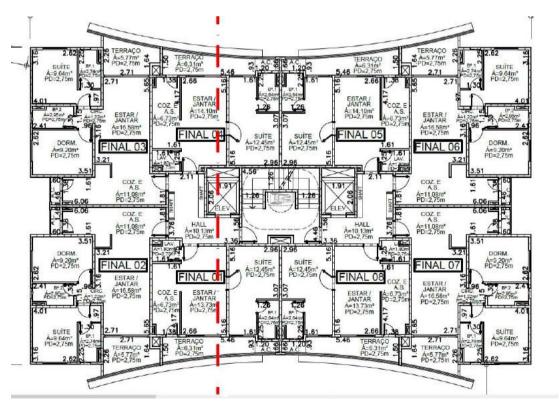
Projeto - Pavimento Tipo. Torres 3 e 4.
